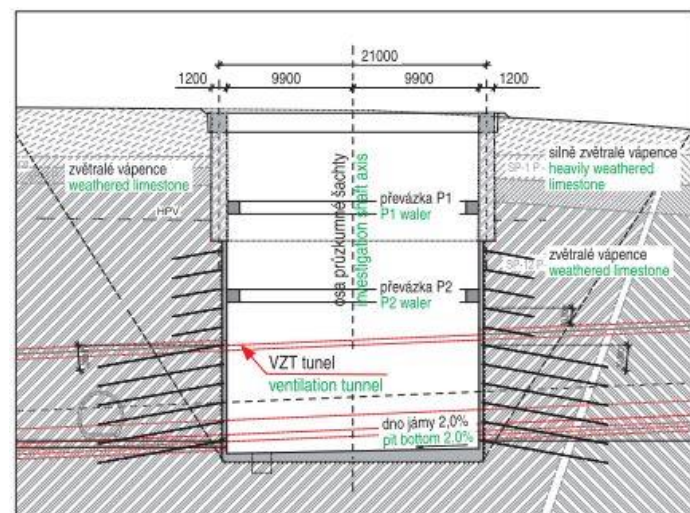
Podélný řez průzkumným dílem OL1 [12]
